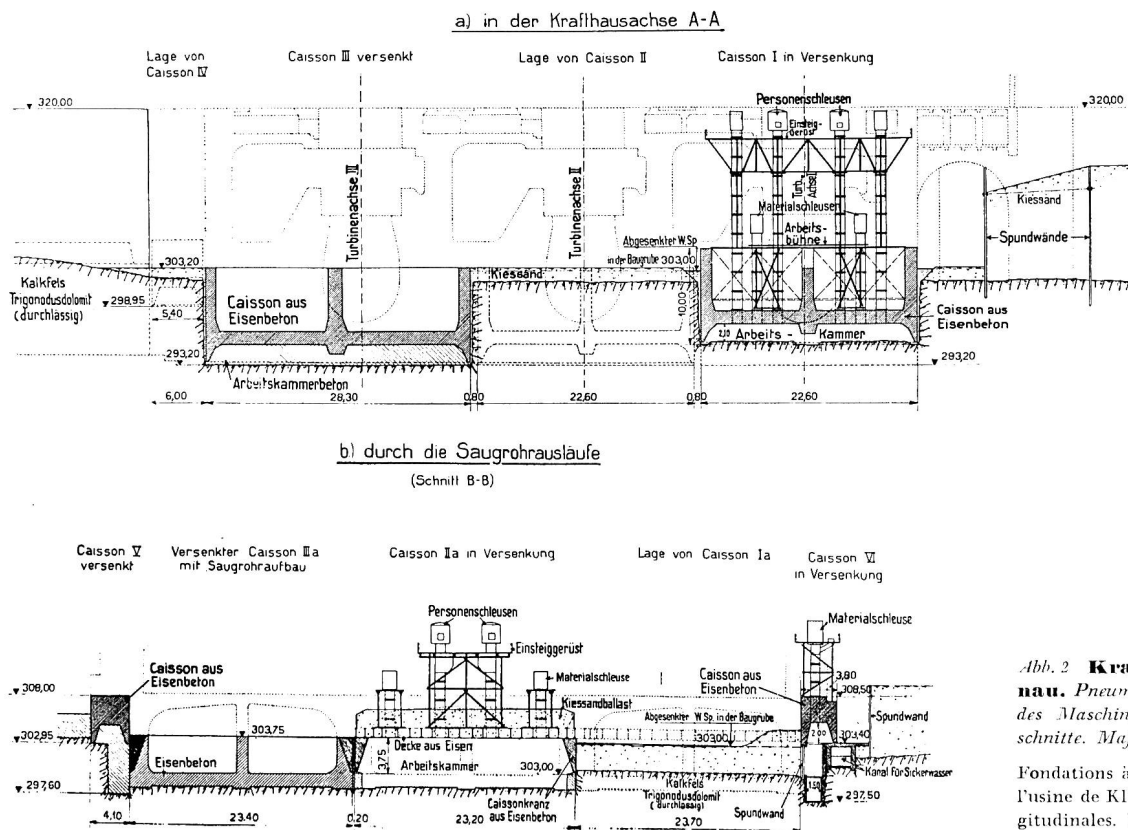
Kraftwerk Klingnau. Pneumatische Fundierung des Maschinen-Hauses. Längsschnitte. Maßstab 1:800
